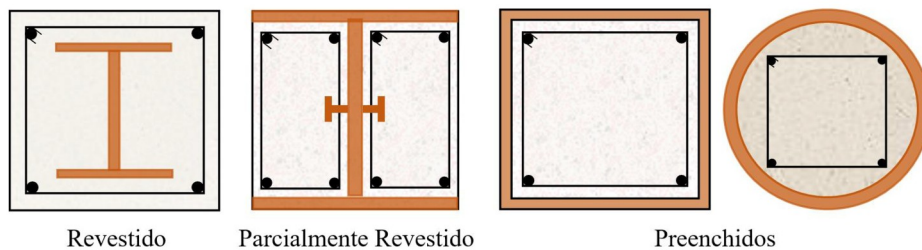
Tipos esquemáticos de pilares mistos Aço-Concreto
